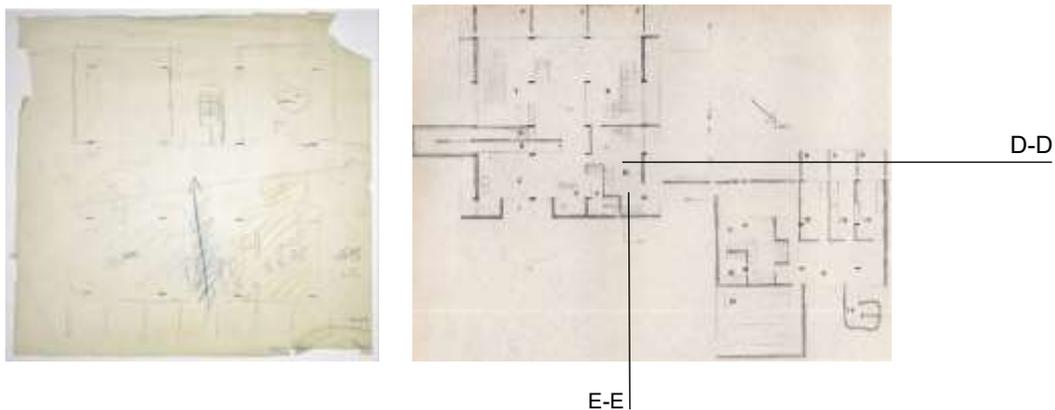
FLC 6453 Nouvelle trame et schéma pleins/vides et plan du Rez-de-chaussée
